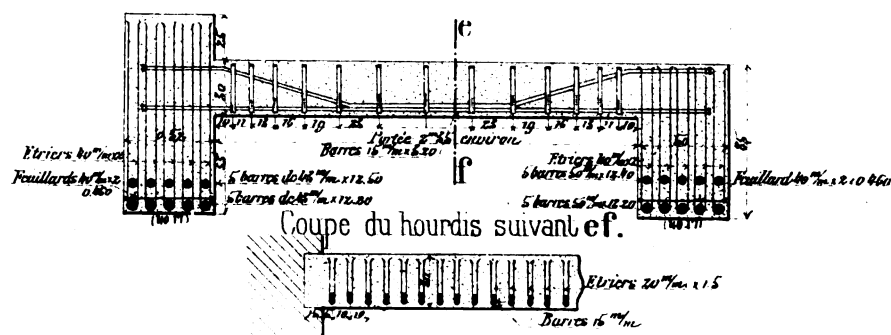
Détail (K) d'une poutre et d'un hourdis en béton armé
